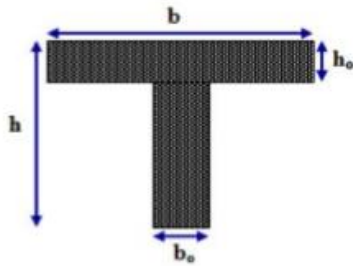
Coupe transversale d'une poutrelle [4]
